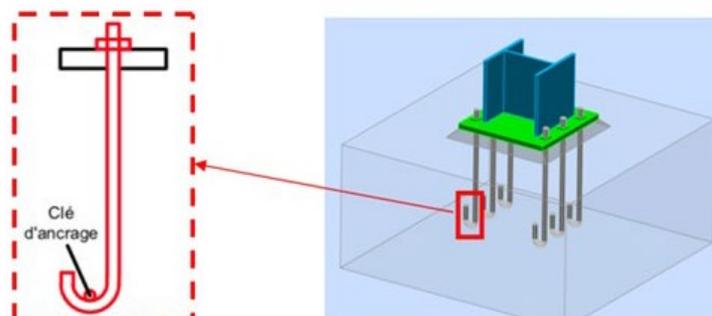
Assemblage du poteau métallique avec la semelle en béton armé ¹²³
